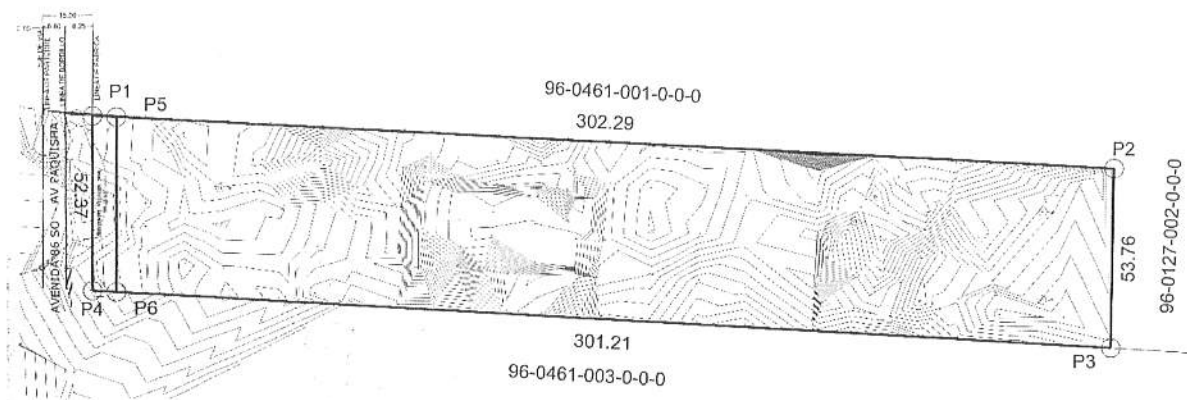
Plano Topográfico Altimetría y Planimetría del Proyecto Mirabella
